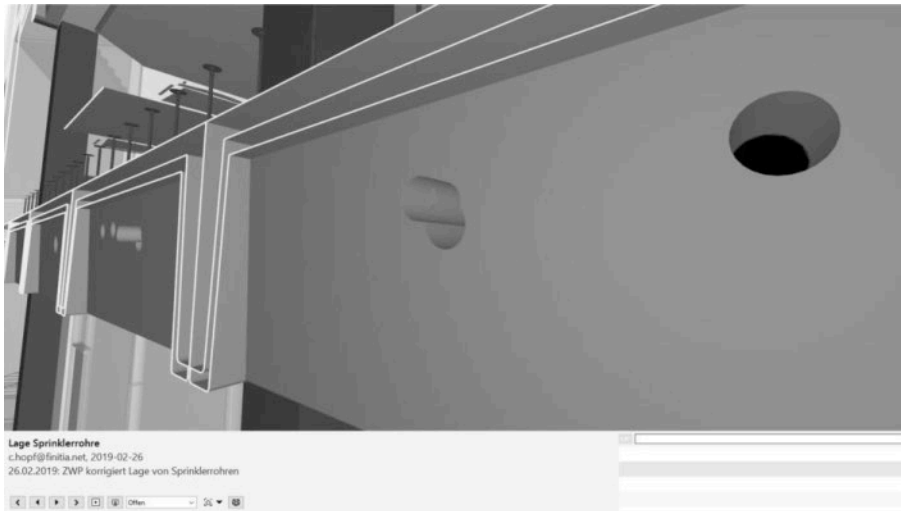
Kollision Sprinklerrohr mit Kassettendeckenelement
